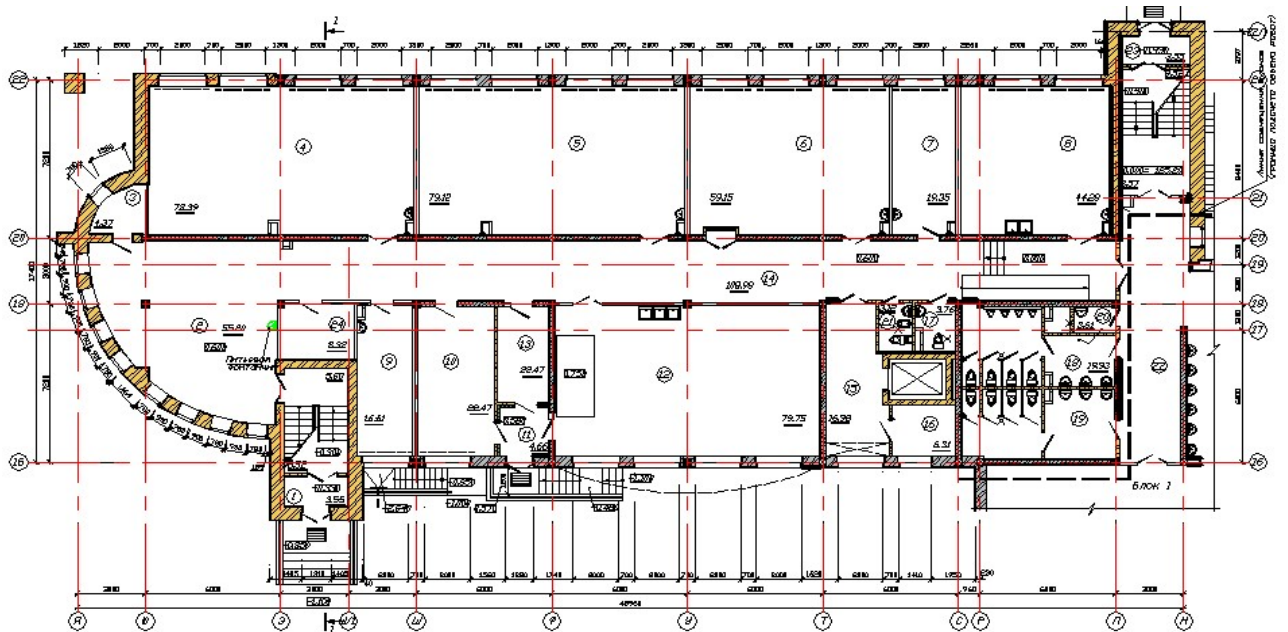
Маркувальний план першого поверху 2-го блоку на позначці 0,600
